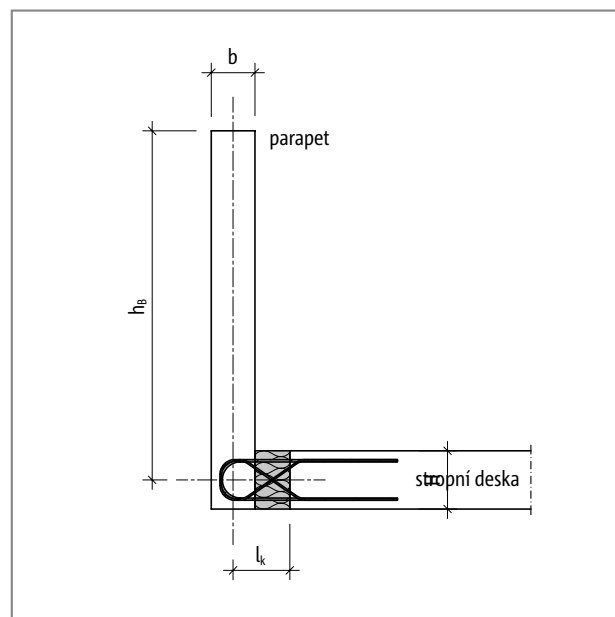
Schöck Isokorb® typ ABXT: Znaménková konvence pro dimenzování parapetů uložených na stropní desce
